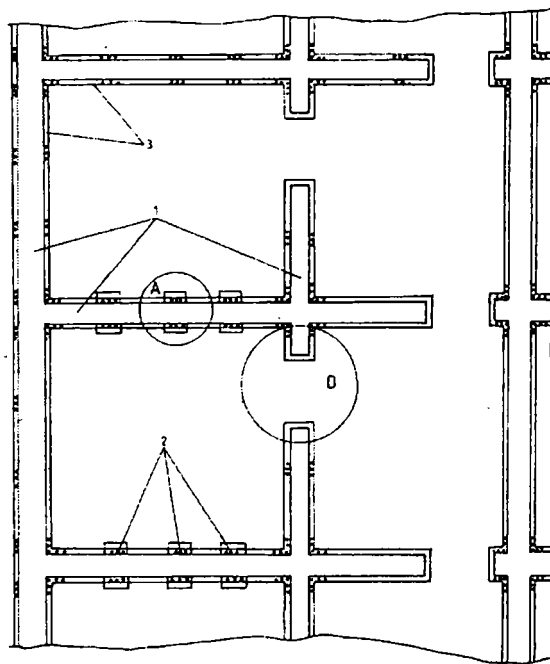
Sectiune prin perete consolidat cu camasuielei din beton armat; 1- pereti de consolidat ; 2- goluri practicate pentru betonare ; 3- camasuiala din beton armat de min 10 cm grosime
